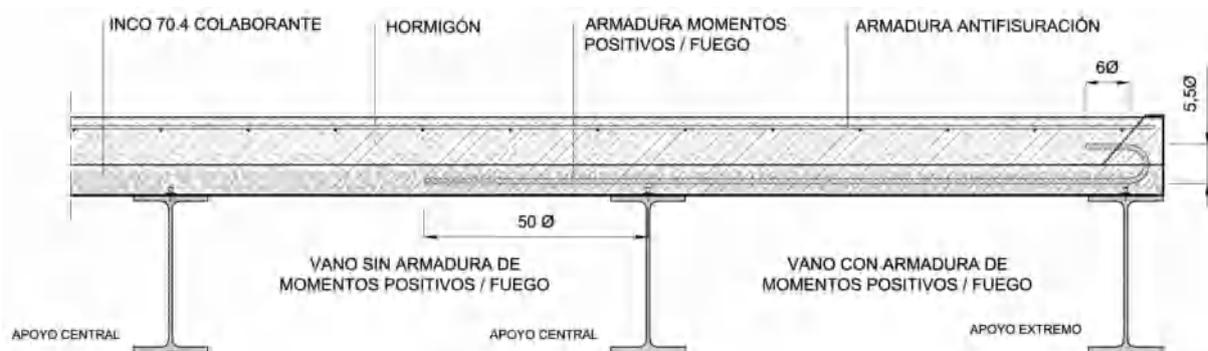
"Disposición de las armaduras de positivos/fuego sobre apoyos intermedios y extremo"
